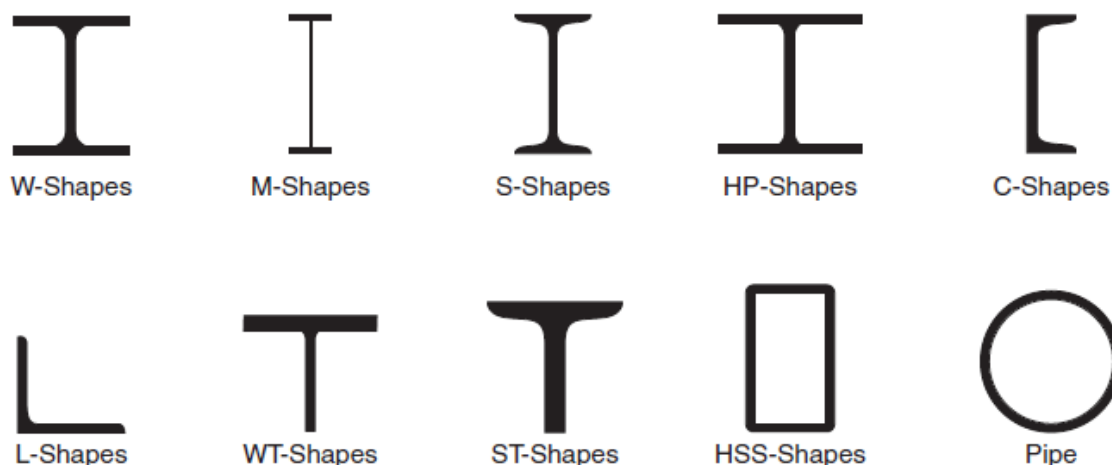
Estándar Perfiles de Acero Estructural Americanos
